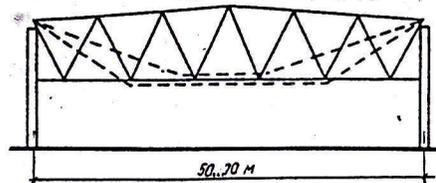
Балкове перекриття з попередньо напруженою фермою та схема наскрізної рами
